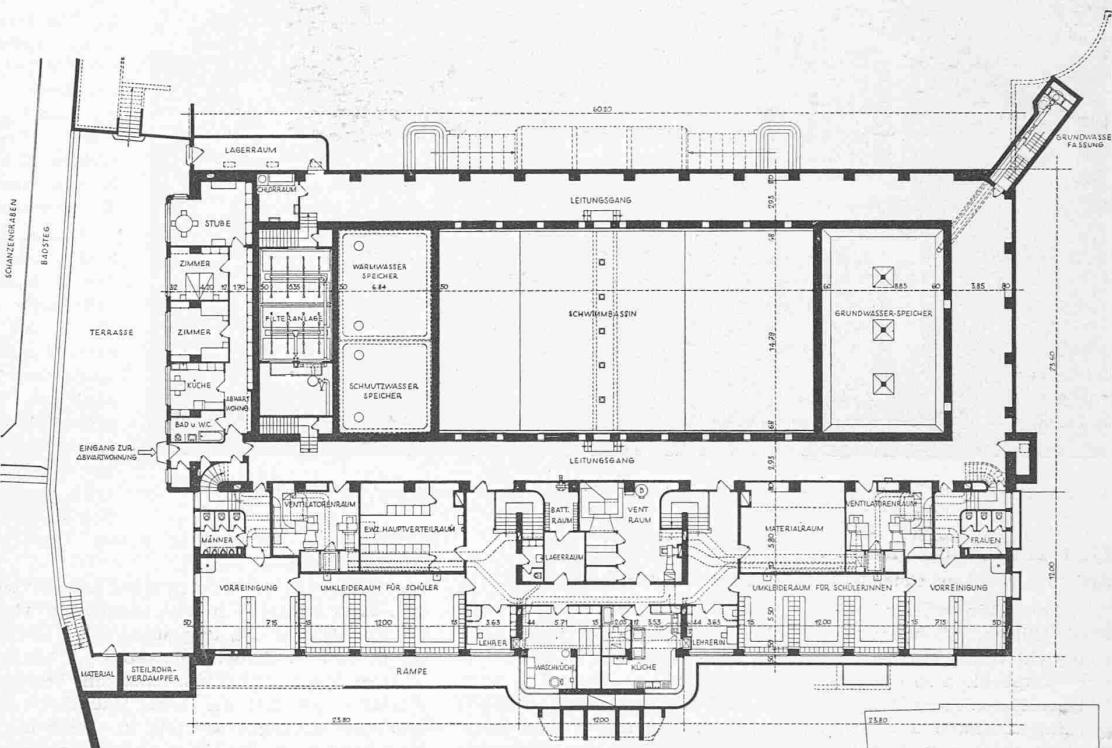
Untergeschoss mit Schüler-Garderoben, links die Abwartwohnung. — Grundriss 1:500
